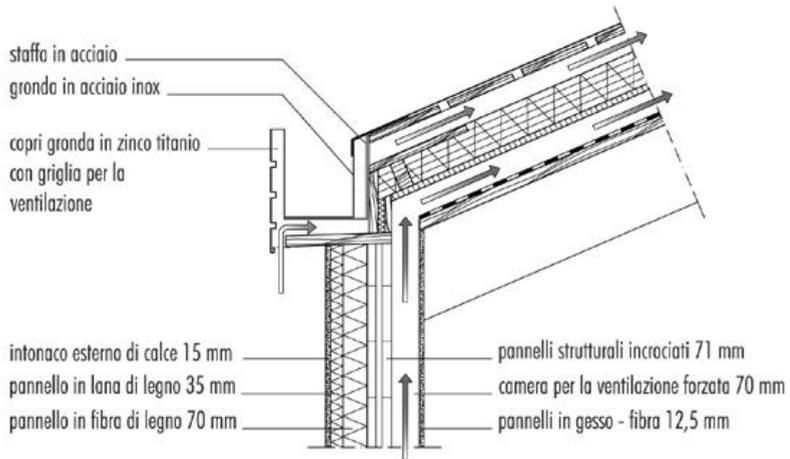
Dettaglio di parete di tamponamento e copertura in legno; la struttura è munita di cappotto esterno e camera di ventilazione forzata interna (ed intradossale nella copertura) distinta dalla ventilazione a circolazione naturale della copertura.
